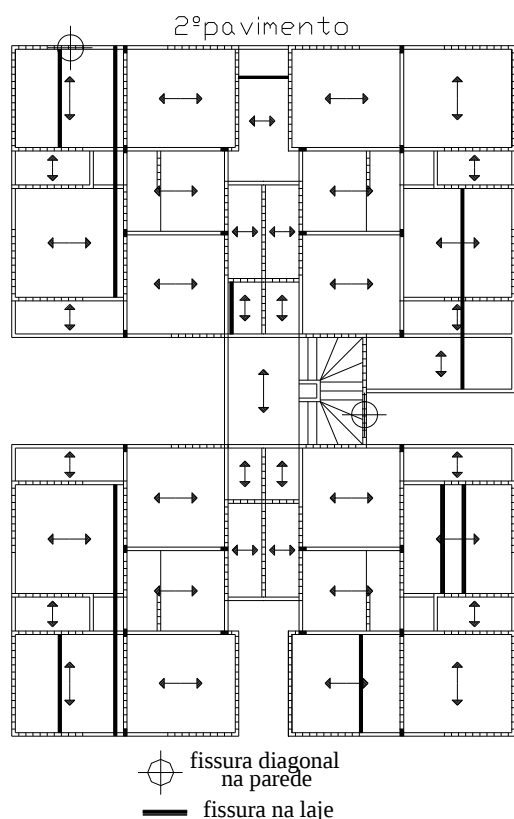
Panorama de fissuração no 2º pavimento.
